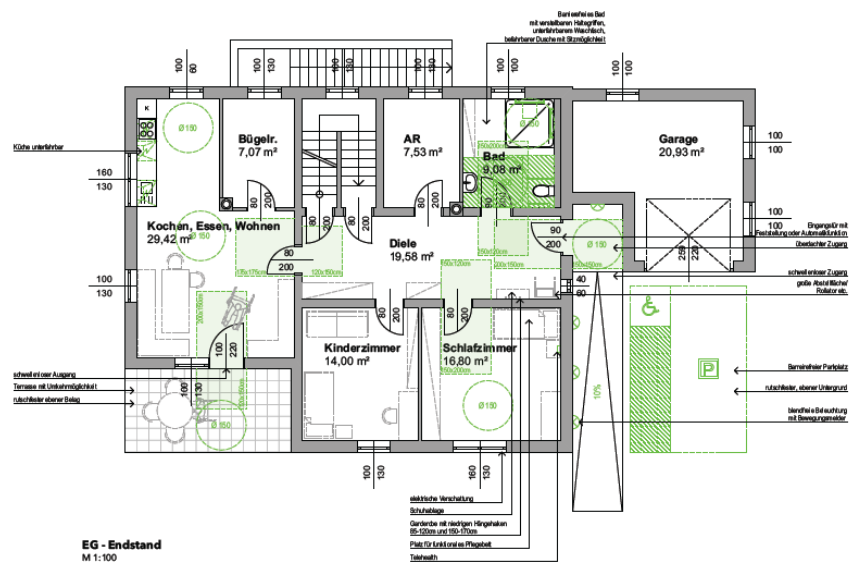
Mustergrundriss eingeschossiges Einfamilienhaus 1987 – Umbau (Maßstab 1:100)
